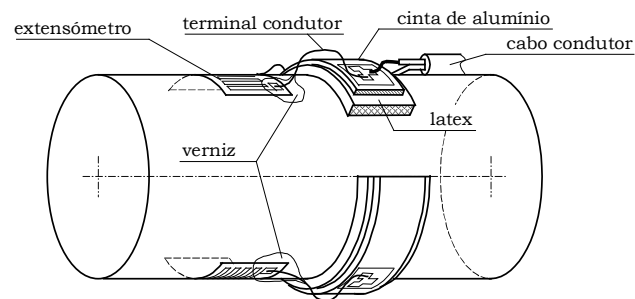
Forma de instrumentação das barras utilizando extensómetros com terminais soldados em fábrica e cinta flexível.
